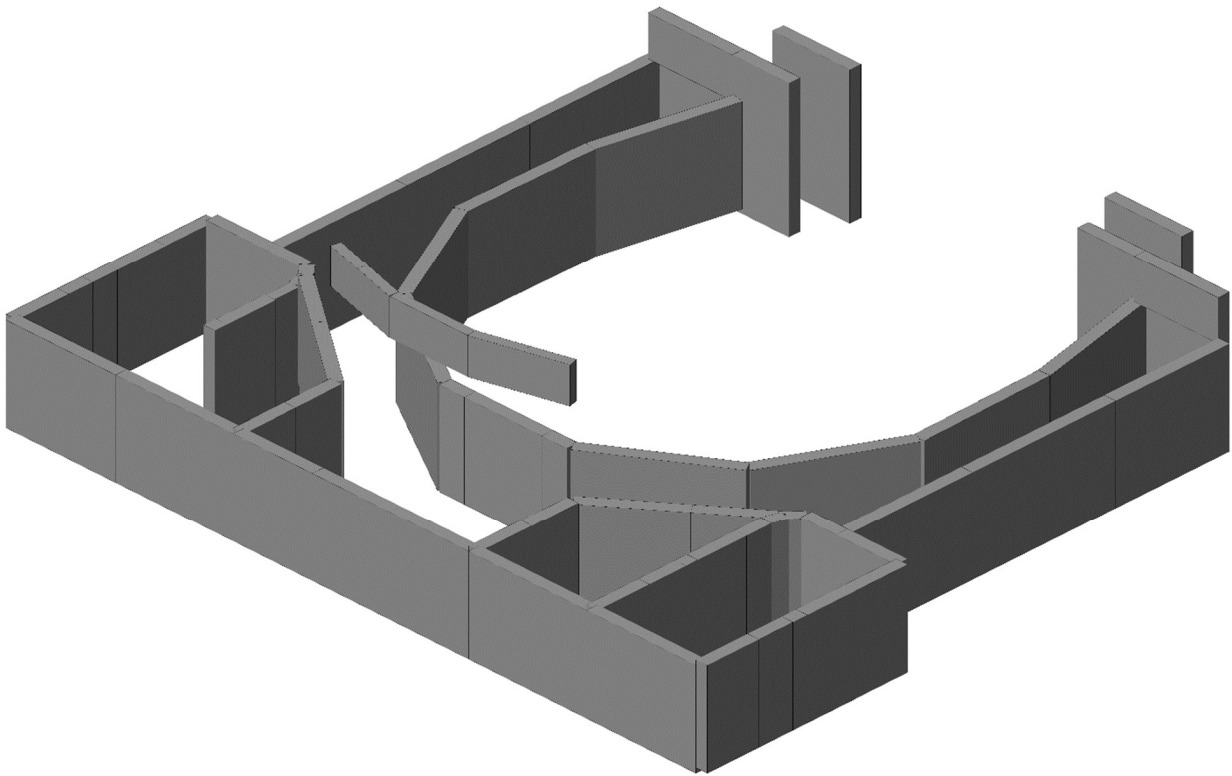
Modellazione dei setti tramite elementi Wall
